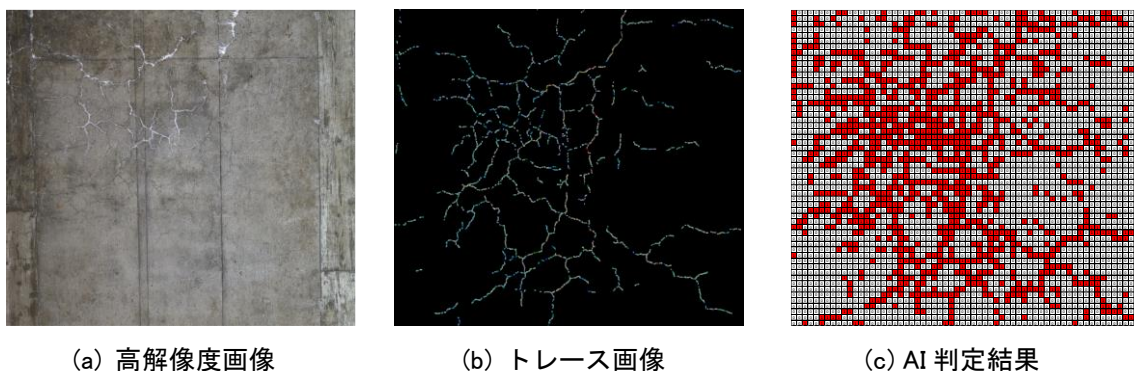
AIによるコンクリート床版下面のひび割れ検出結果の例
